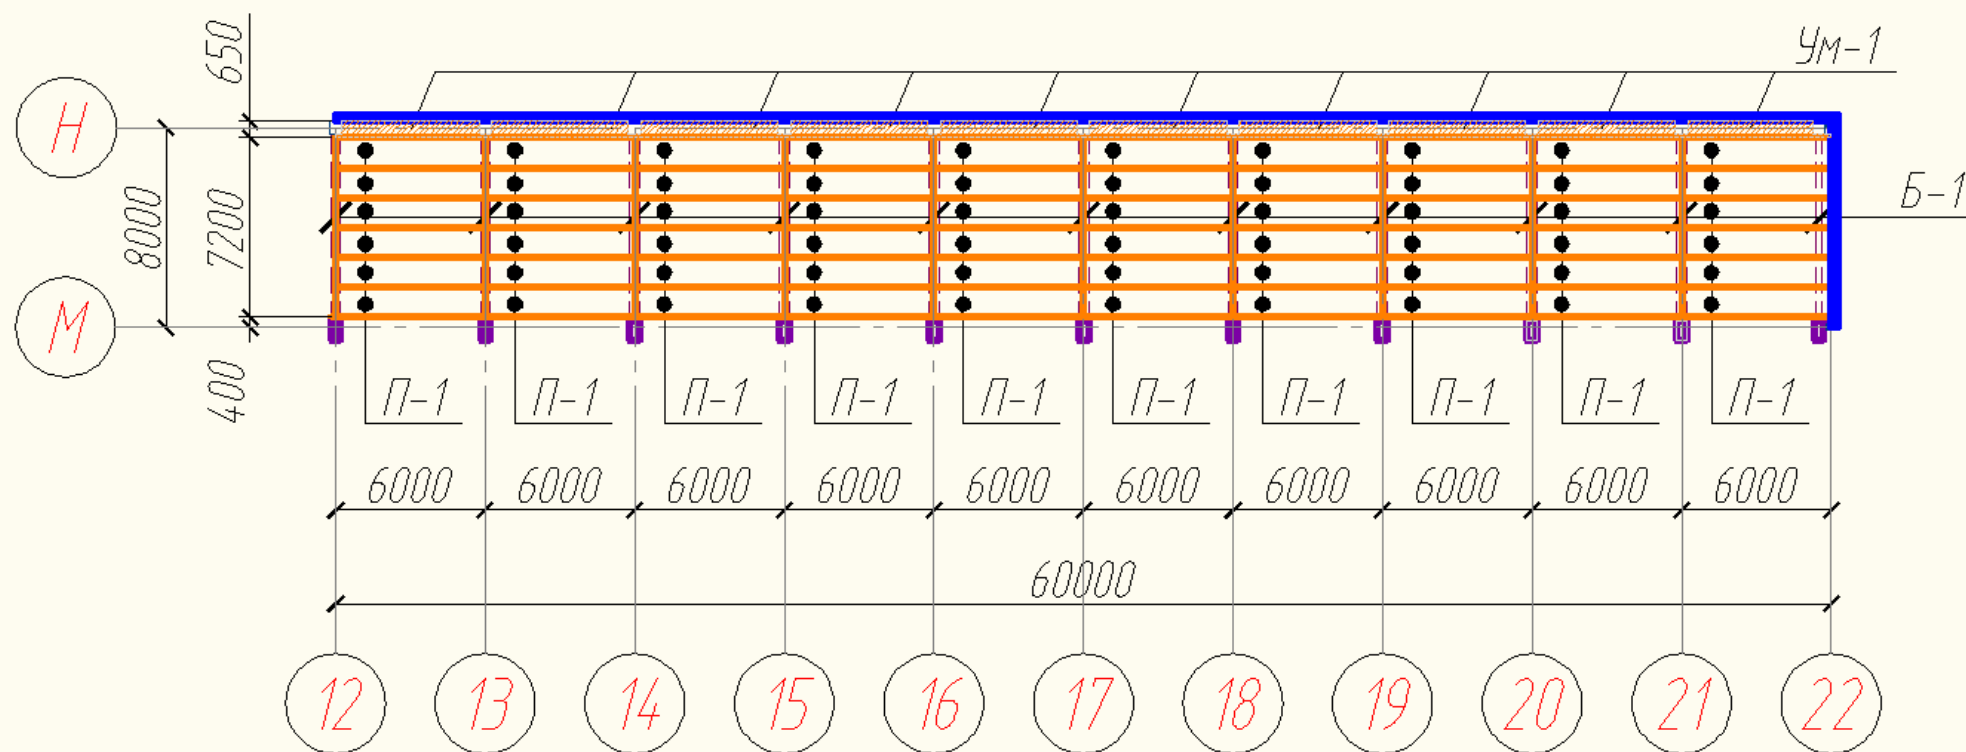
Схема расположения балок и плит перекрытий на отм. низа +3,230 и +6,680 в осях 12-22 и М-Н
